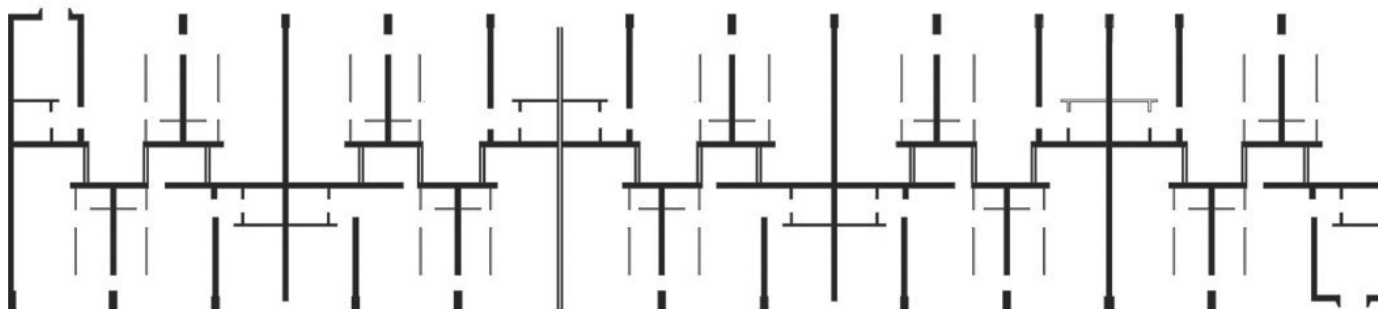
Planta tipo bloques 14-17. Fuente: Elaboración propia.
